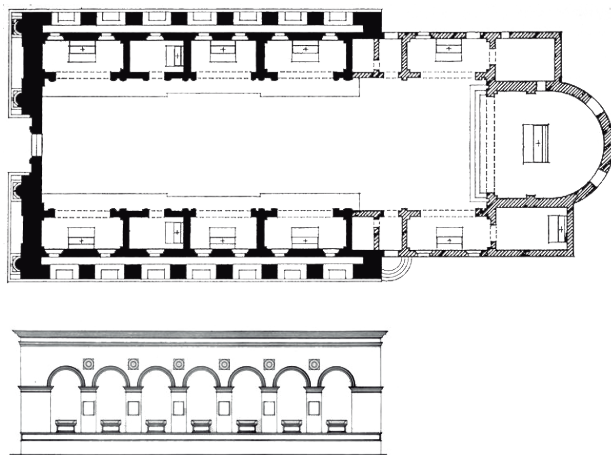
Templo de Malatestiano, Rimini, Siglo XV - Planta y Alzado
